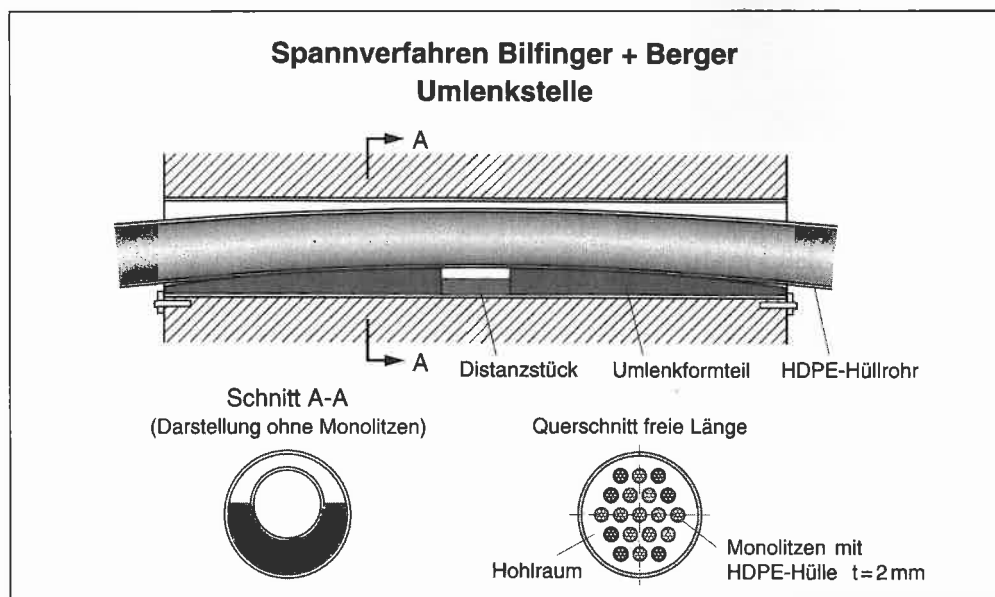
Geplantes Spannglied der Fa. BBV, Monolitzen mit verstärktem HDPE-Mantel
